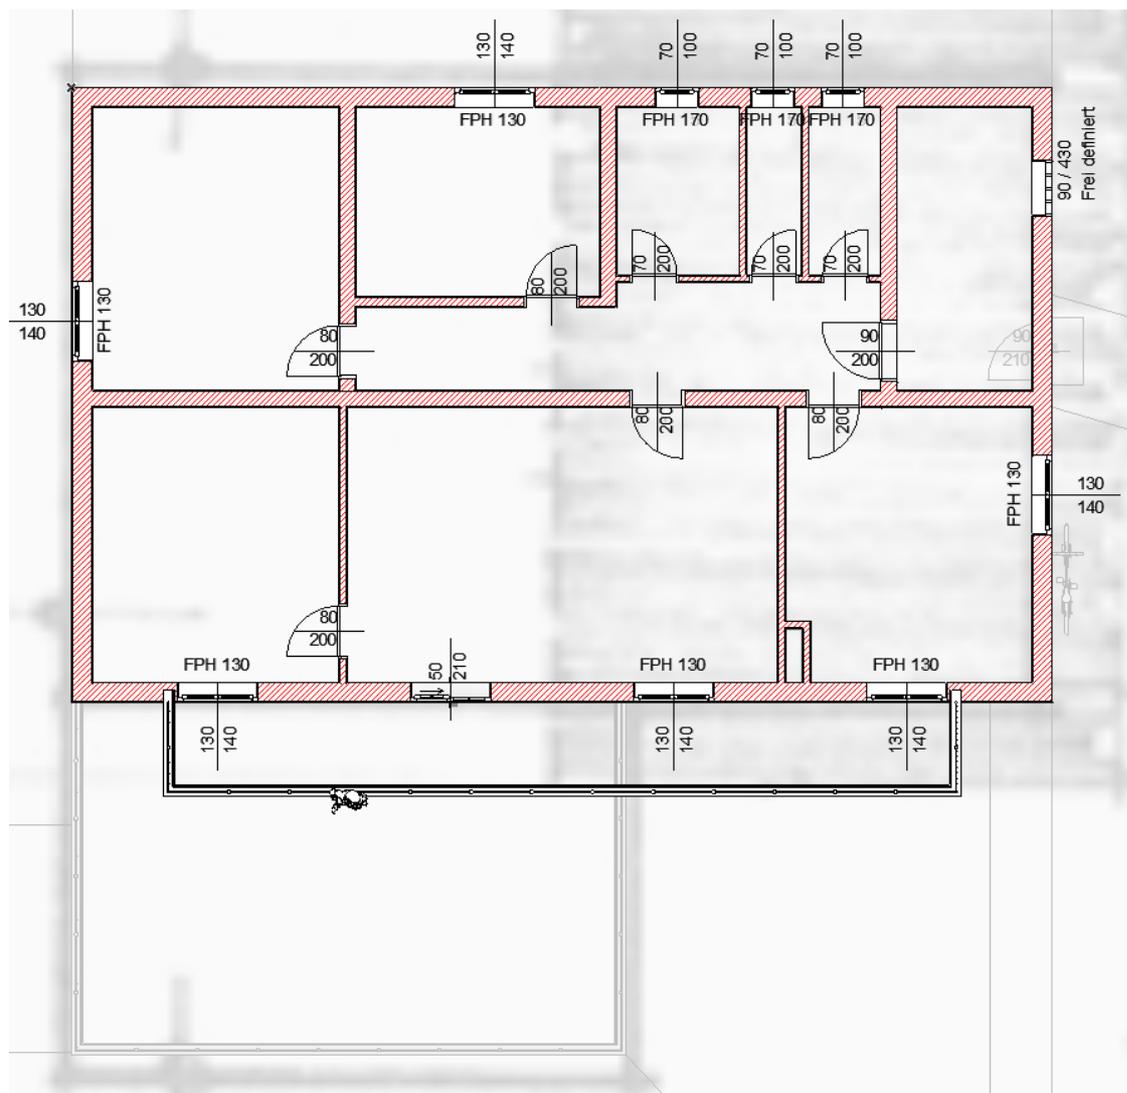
Grundriss Bestandsgebäude 1.Obergeschoss [50]
